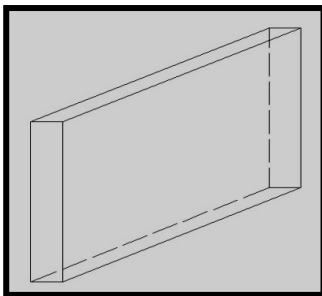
Pilar empesillado. Fuente: Propia.
